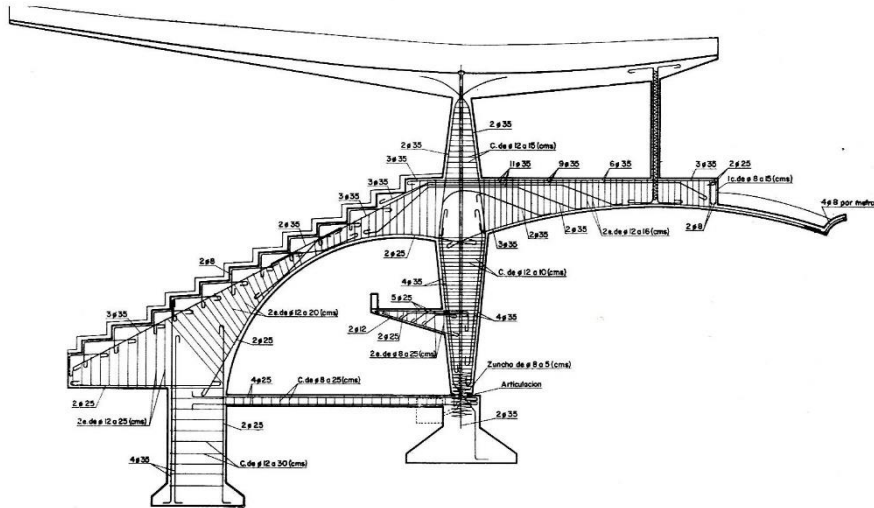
Sección constructiva de la tribuna construida. (Fuente: Libro “Eduardo Torroja Ingeniero”, 1999)
